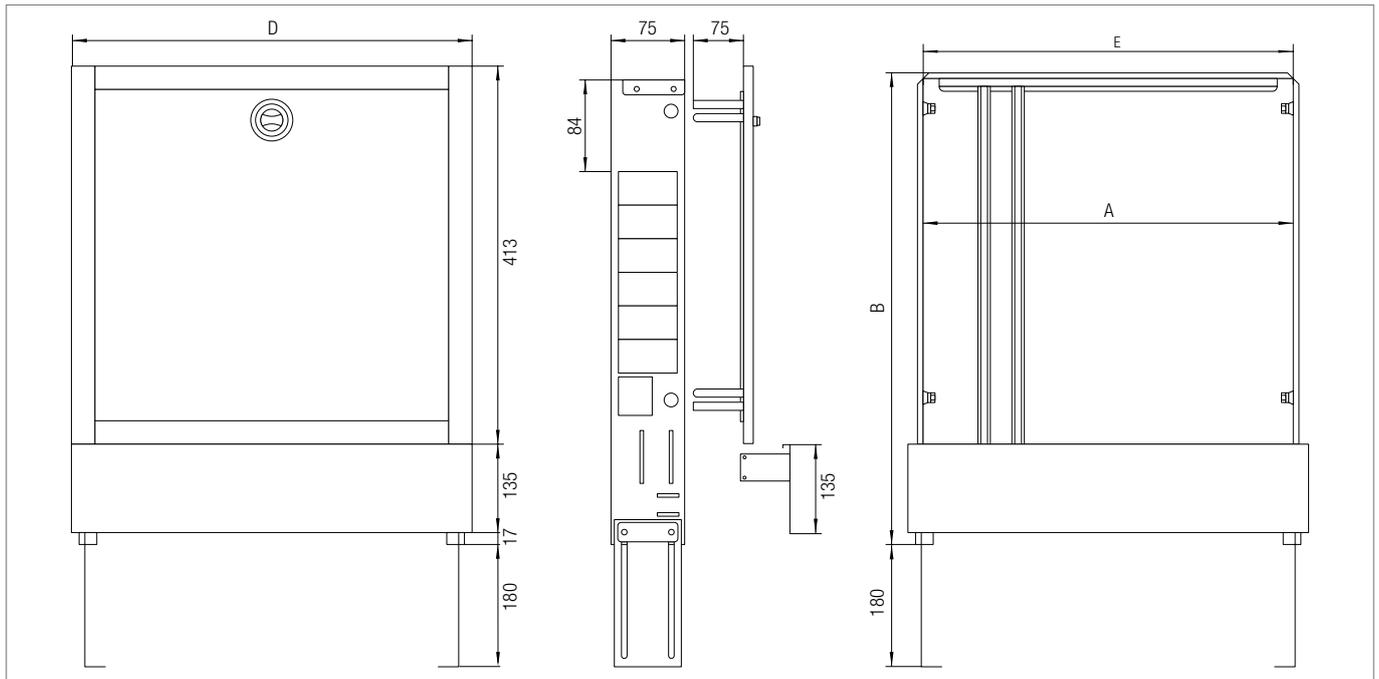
Dimensions coffret pour collecteur compact UP 75
